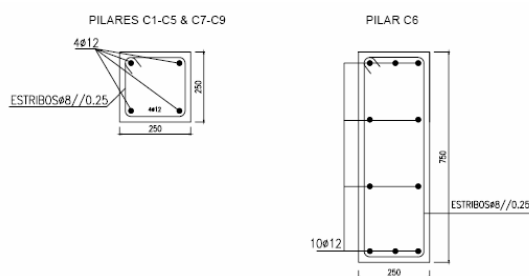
Secção e pormenorização dos pilares [mm] [Massena, 2004].
